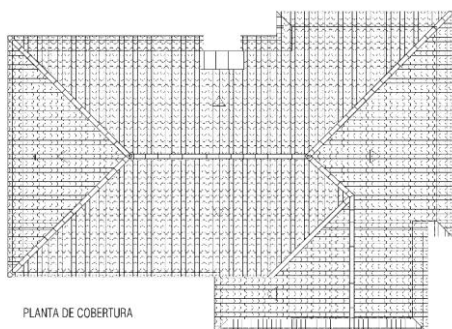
Planta cobertura - In: Arq. Carla Vieira da Silva
